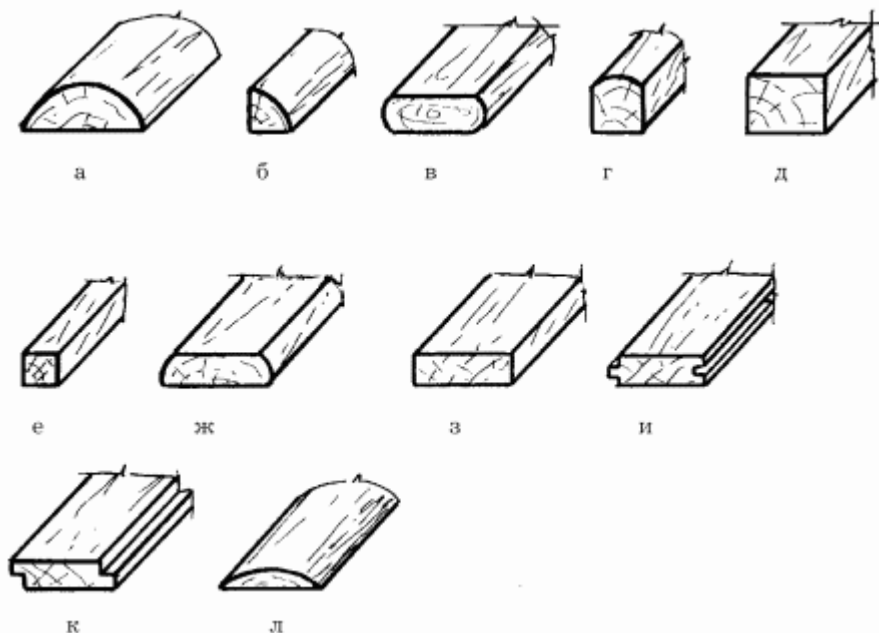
Пиломатериалы: а – пластина; б – четвертина; в – двухкантный брус; г – трехкантный брус; д – четырехкантный брус; е – брусок; ж – необрезная доска; з – обрезная доска; и – шпунтованная доска; к – фальцованная доска; л – горбыль.
